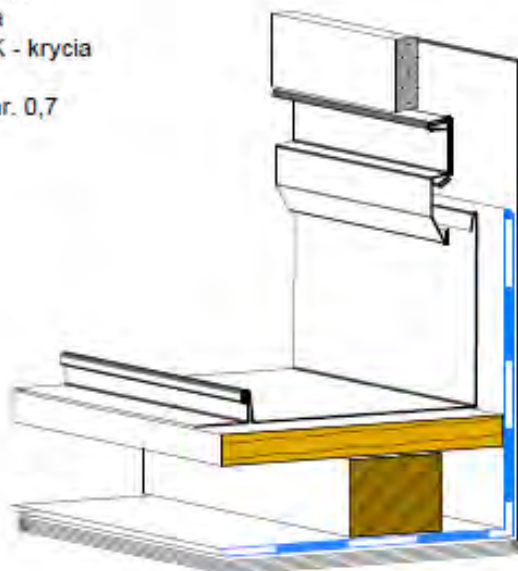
Detail bočného lemovania pri stene, drážkovaná krytina
